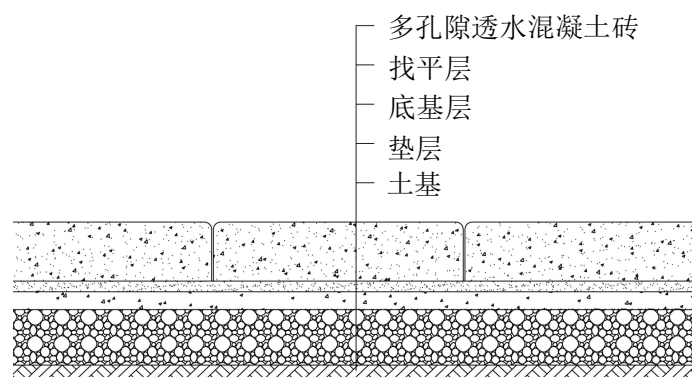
多孔隙透水混凝土砖路面结构层示意图
